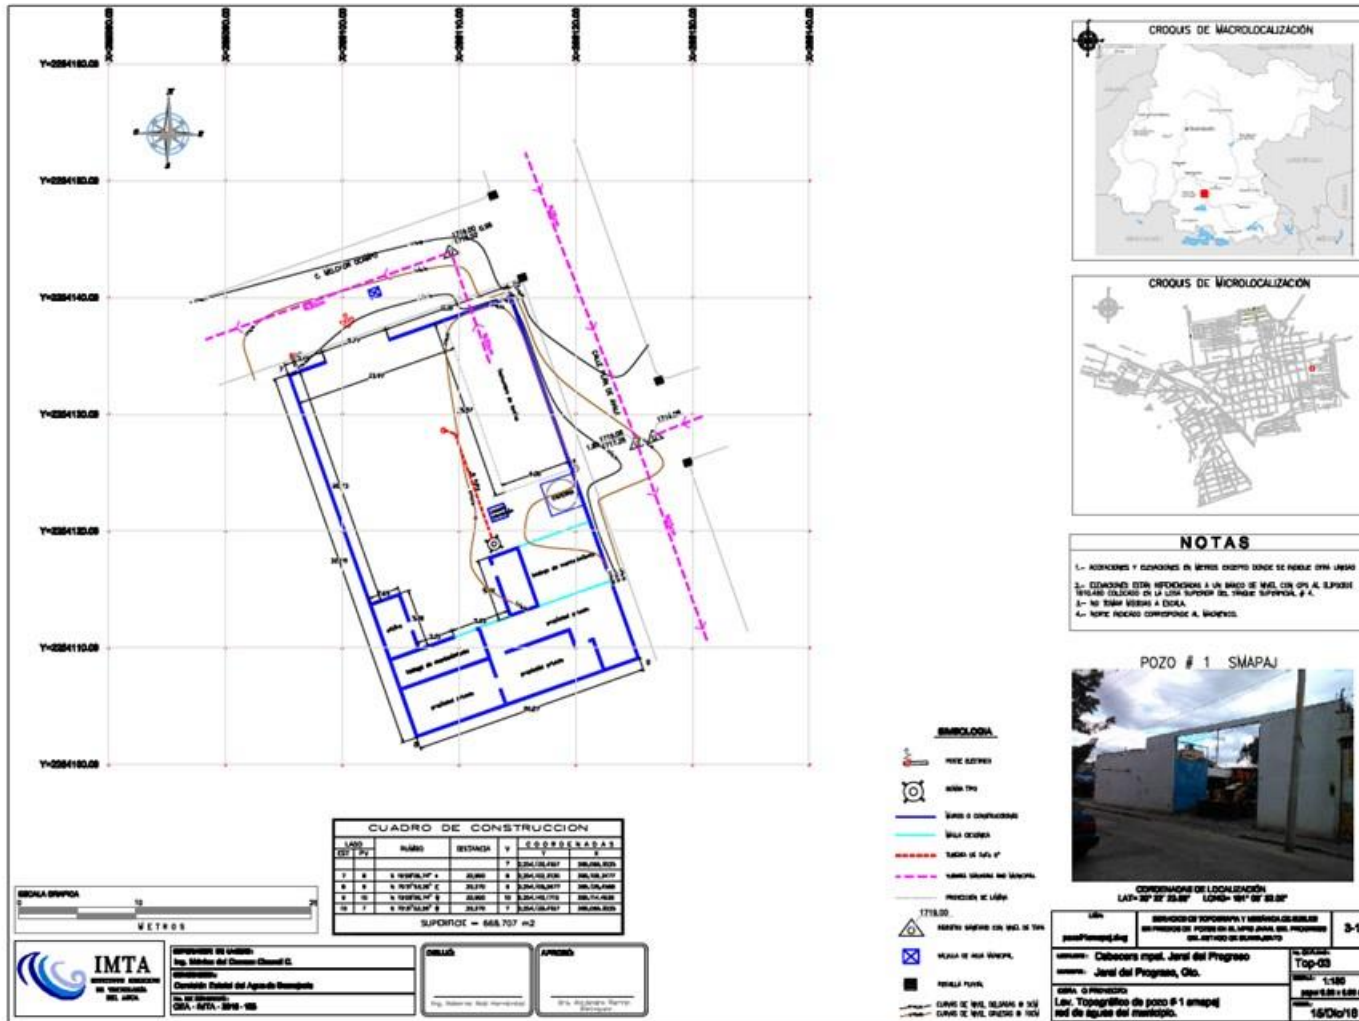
Levantamiento Pozo 1 (Ver anexo de planos para más detalle)
